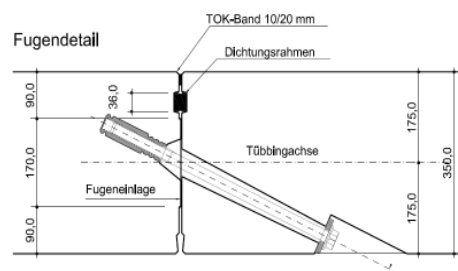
Tübbingfuge, Tunnel geschlossene Bauweise (Schildbauweise)
